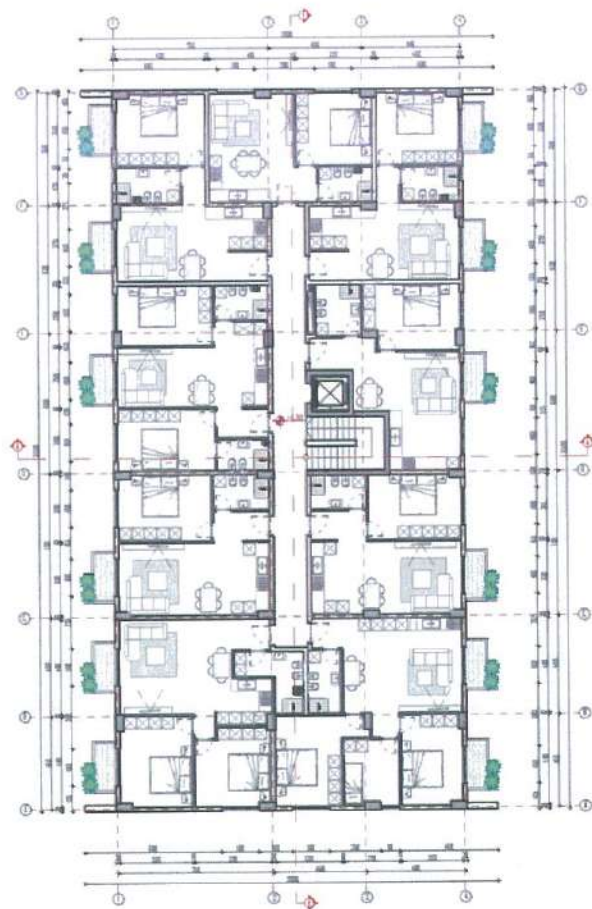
Planimetria e katit të dytë & katërt, objekti 3 & 4
